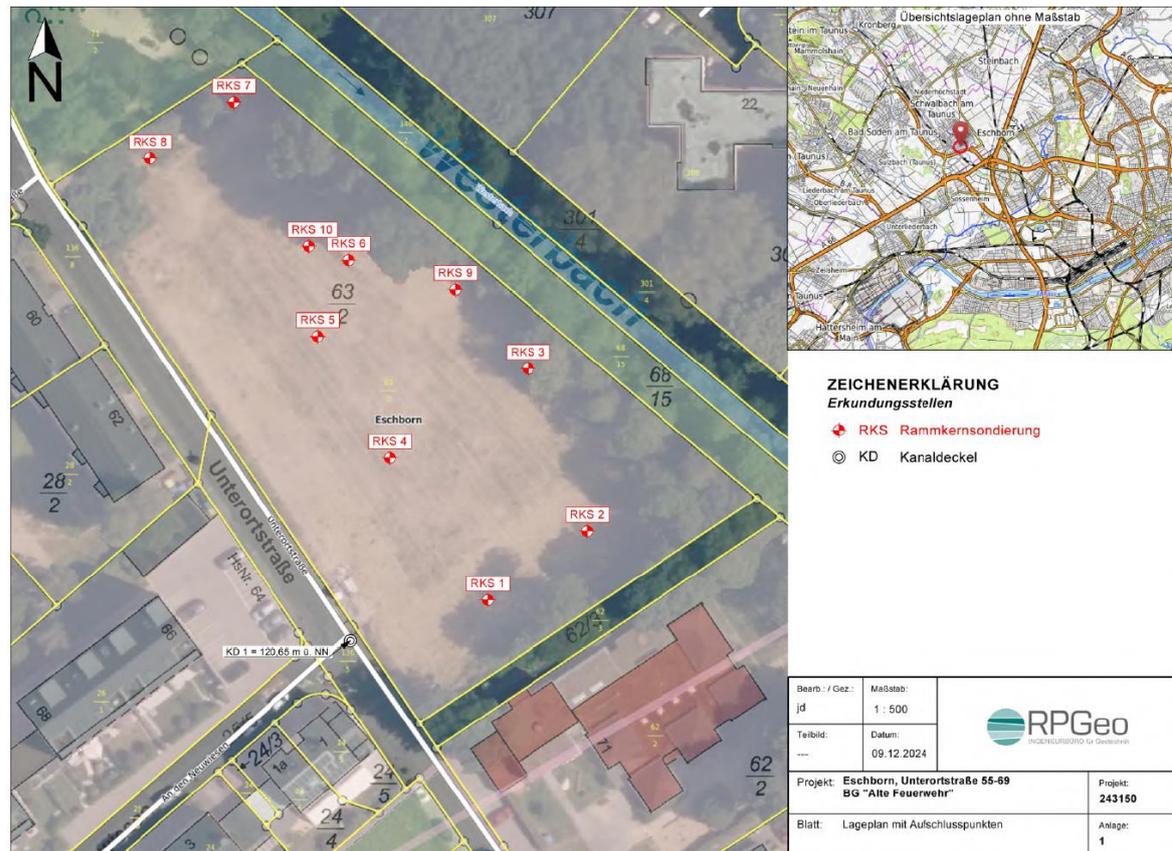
Erkundungsstellen im Plangebiet – Quelle: RPGeo
